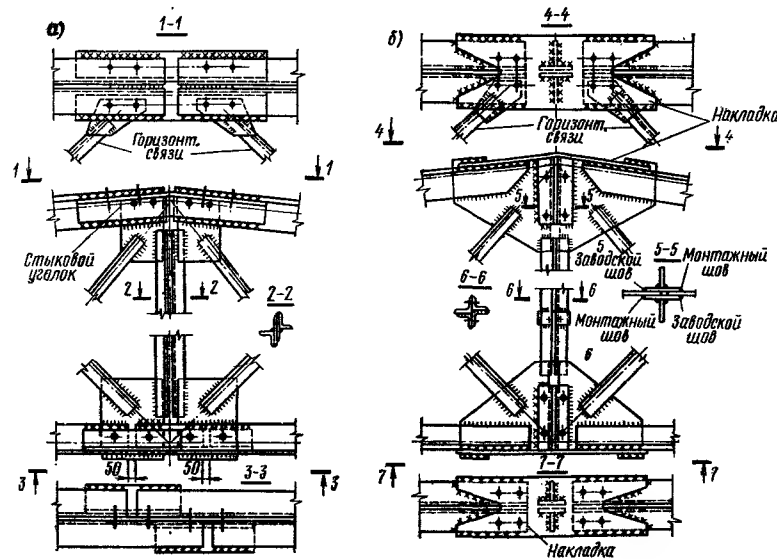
Монтажные стыки верхнего и нижнего поясов ферм
